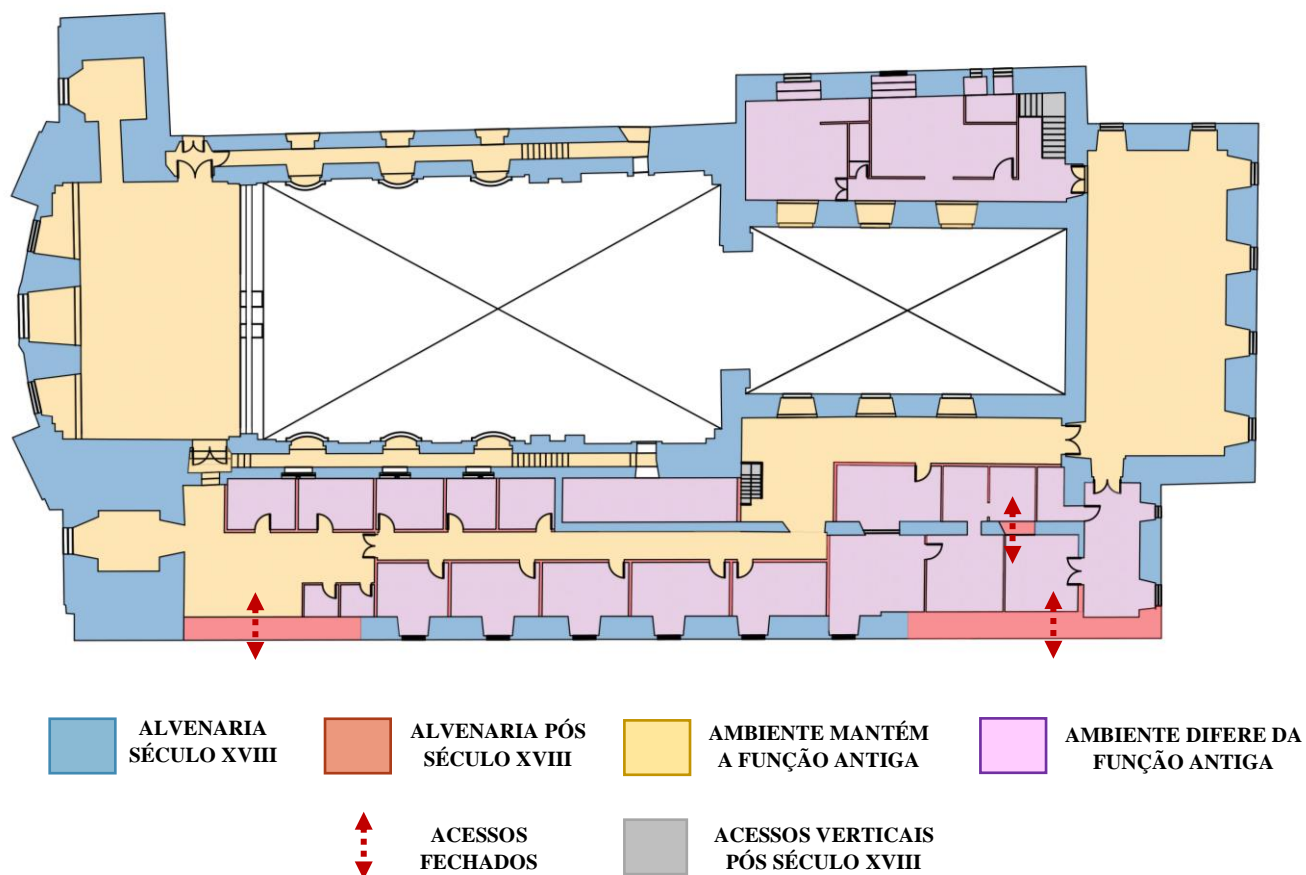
Análise da planta do pavimento térreo da Igreja das Mercês, rebatendo informações da planta de 1753 sobre a atual.
